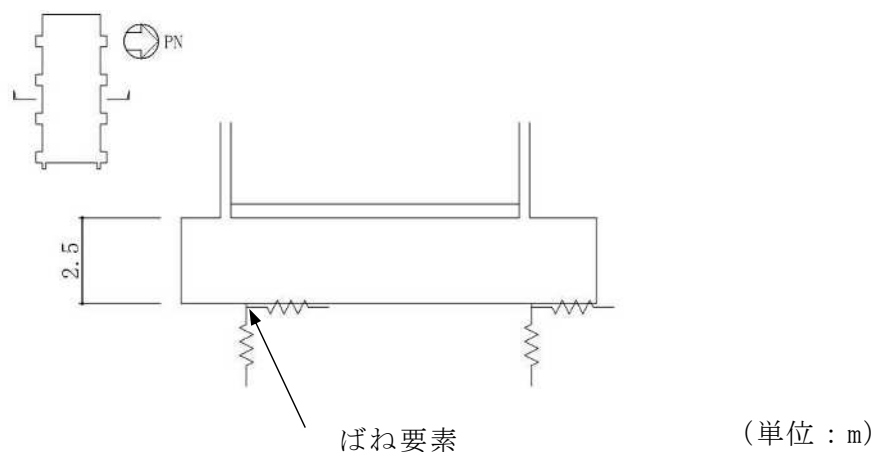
基礎スラブの解析モデル図（断面図）（2/2）
